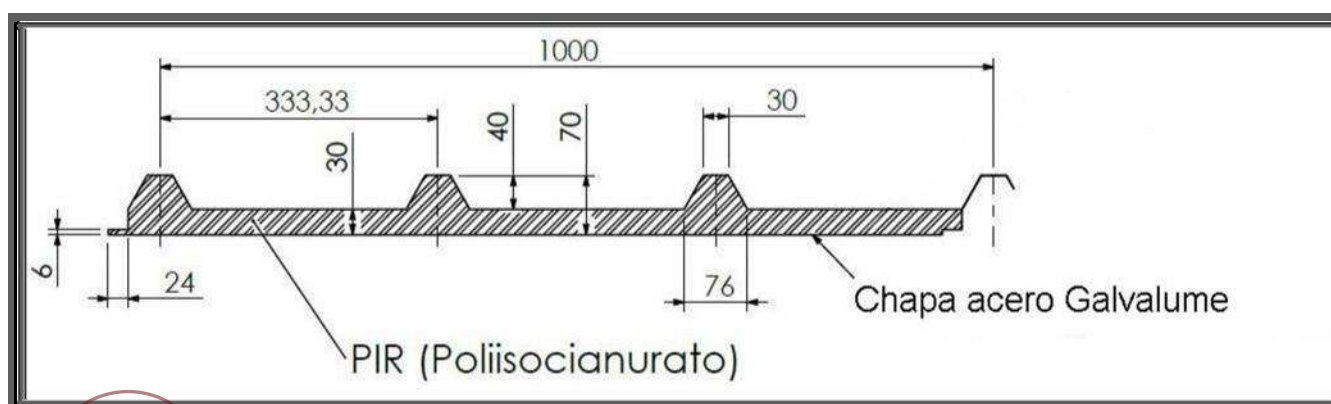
Sección transversal del panel del techo (Dimensiones en mm).
